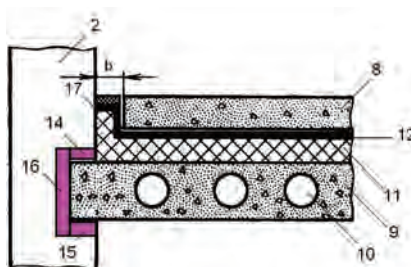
Фрагмент междуэтажного перекрытия здания в разрезе
